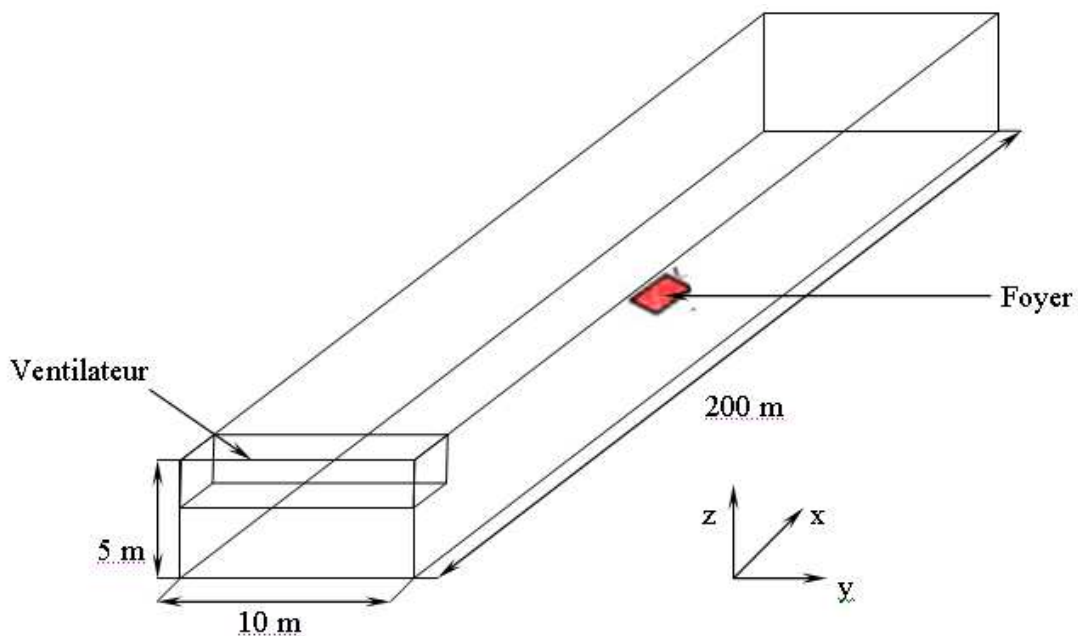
Schéma d'un tunnel routier muni d'une ventilation longitudinale.
